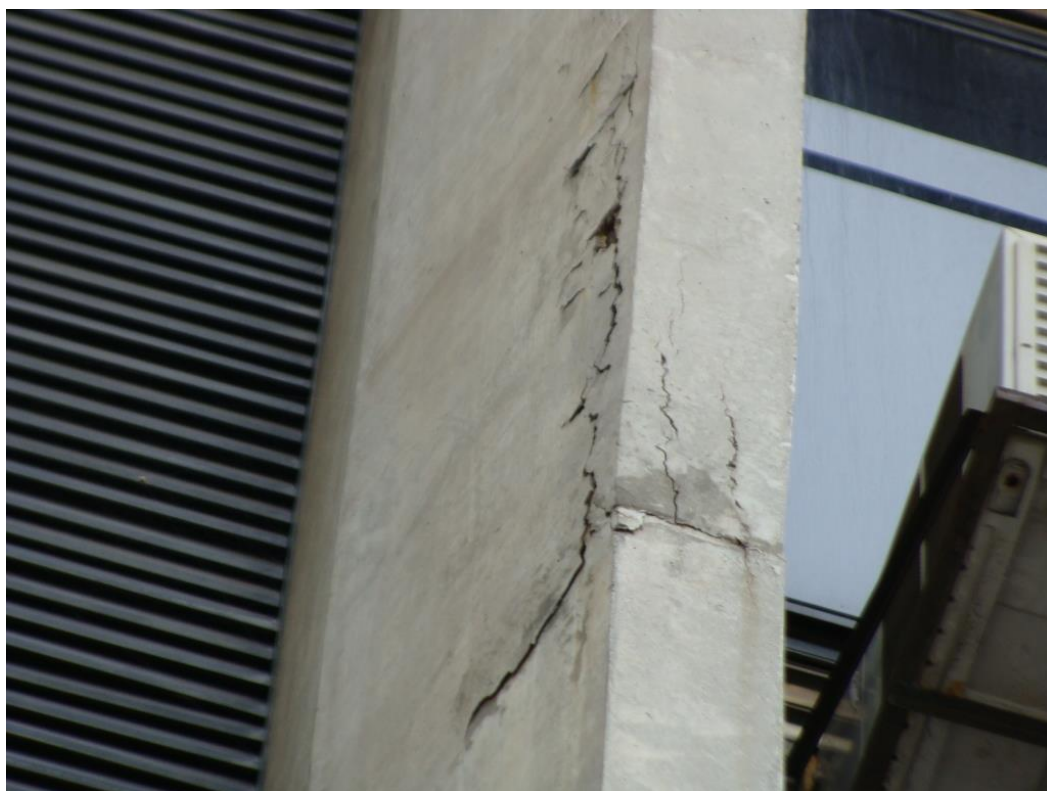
Armadura exposta pilar P13 (2º pavimento) (02/03/2021)
